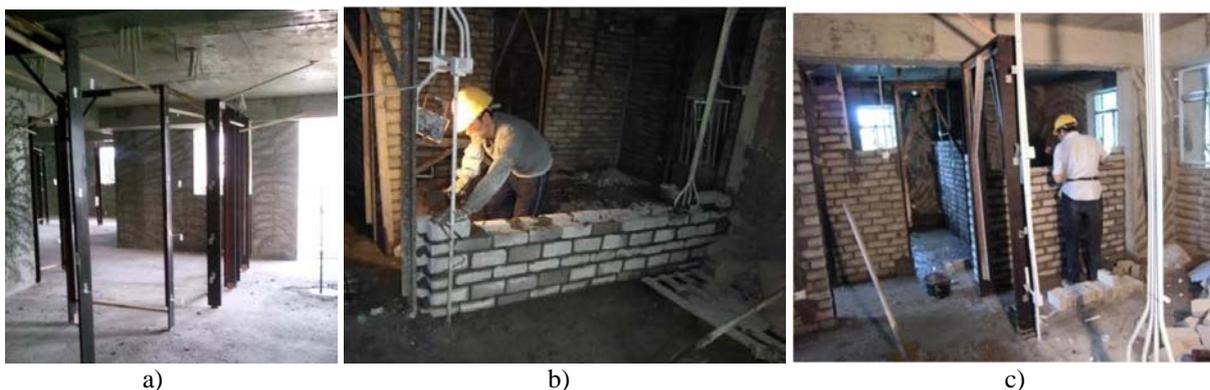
Pormenores construtivos execução de panos de alvenaria
